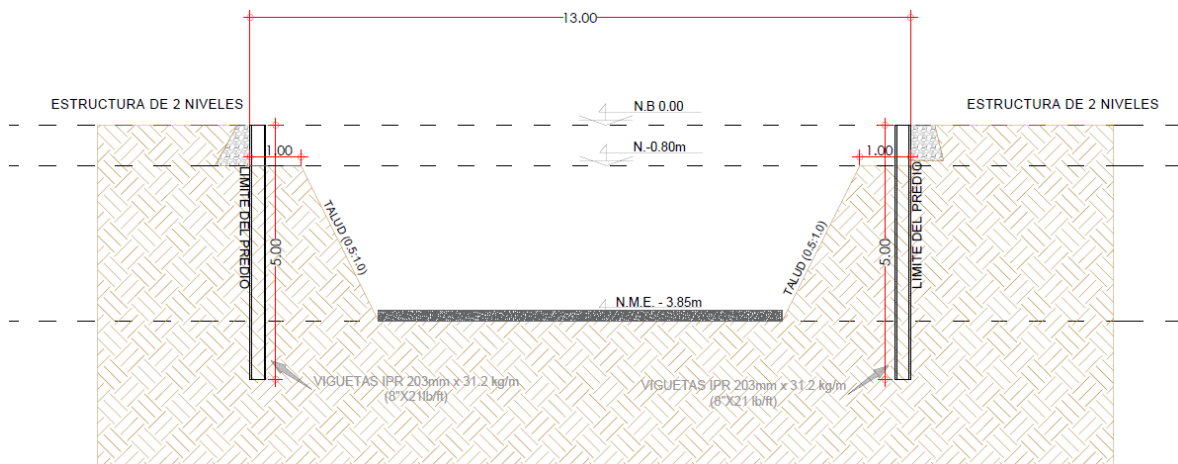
CONSTRUCCIÓN DE LA ZONA CENTRAL
